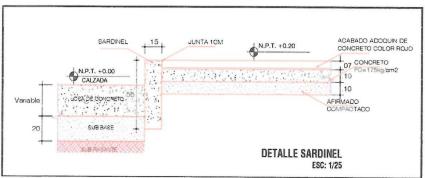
Detalle del sardinel y vereda (imagen referencial-ver detalles y medidas proyectadas en planos).
